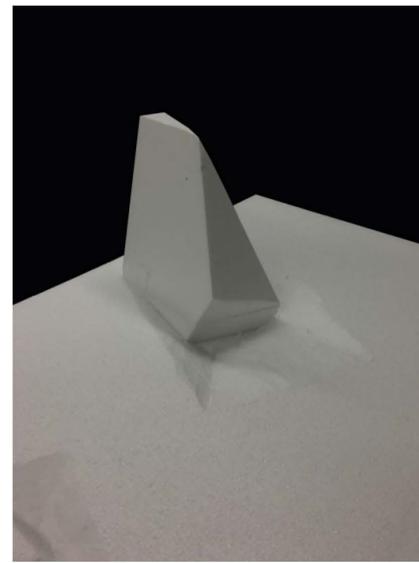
Maquete de estudo da rampa de acesso escala 1:100
